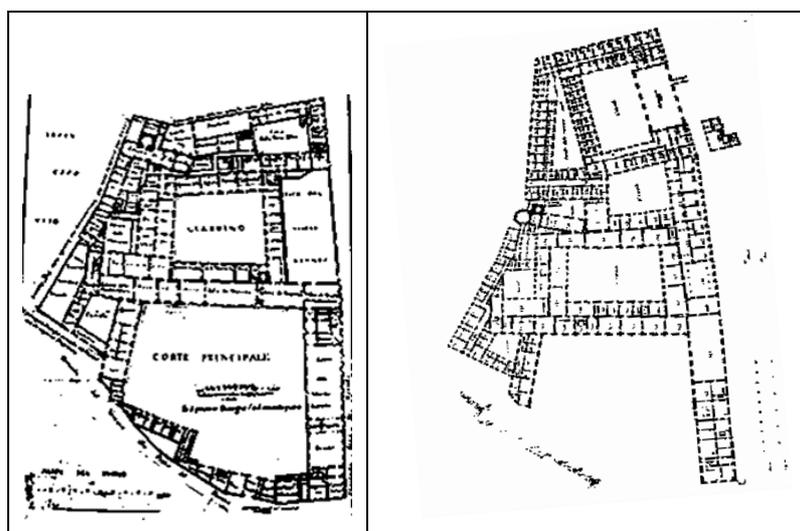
Planimetria del Palazzo Ducale nel primo Settecento e dopo l’intervento del Piermarini
